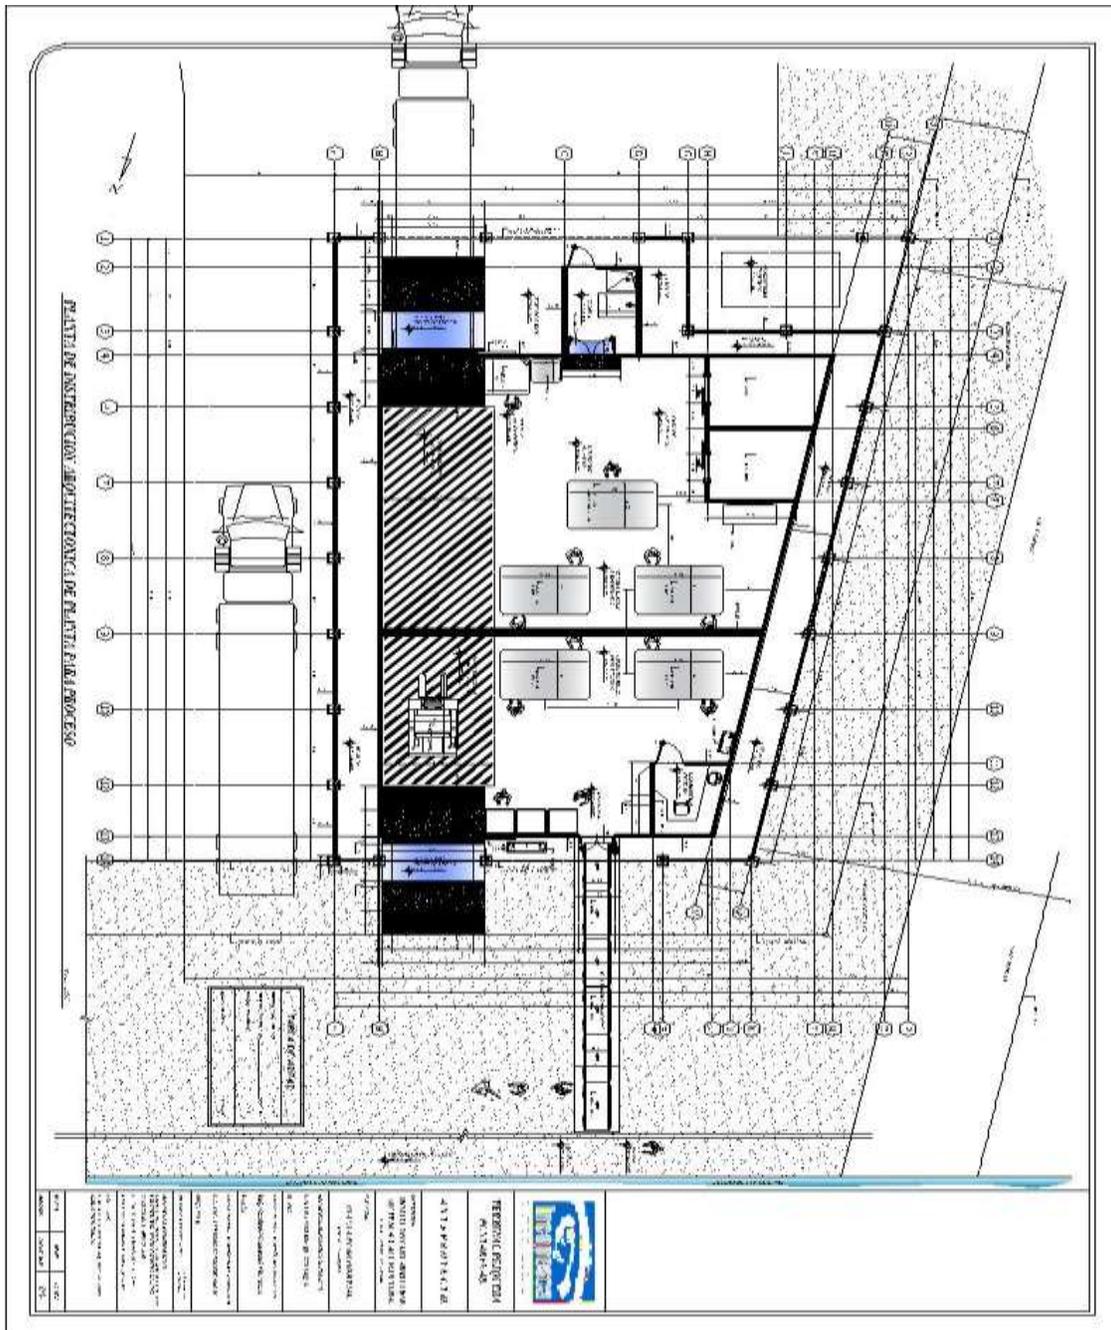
Planta de distribución arquitectónica de Planta de Proceso
